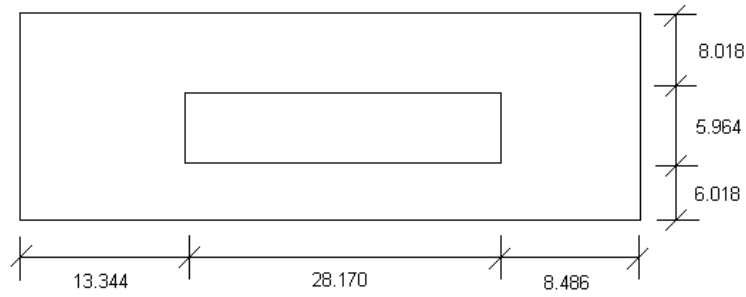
Muro equivalente al muro 16 (dimensiones en pies).
